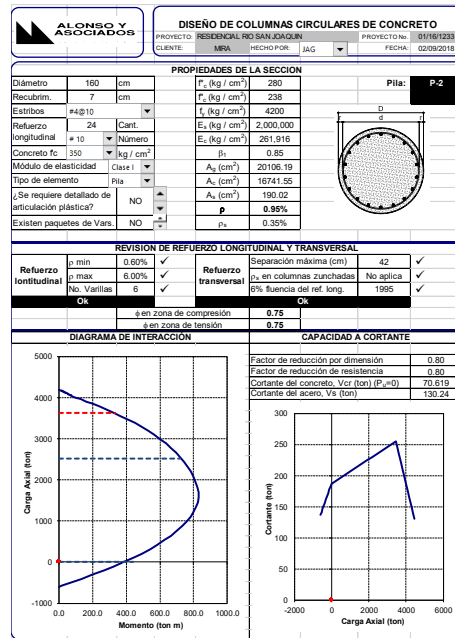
Diseño pila tipo P-2 con diámetro 1.60 m
